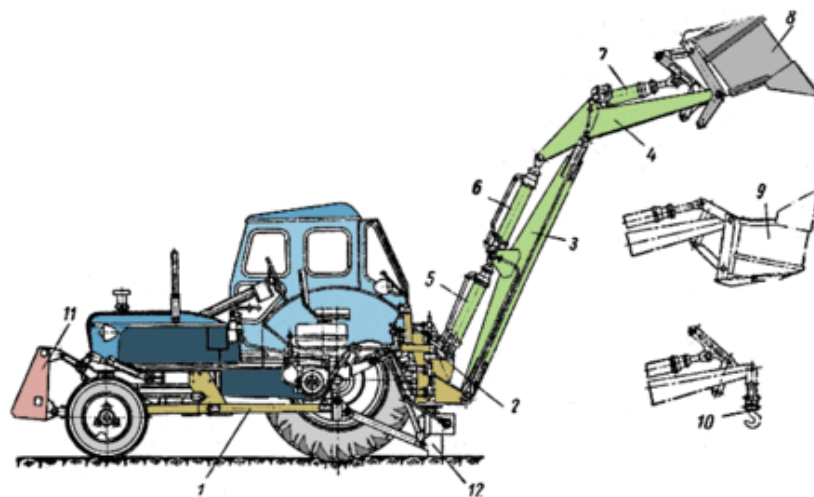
Схема неполноповоротного экскаватора на шасси колёсного трактора:
